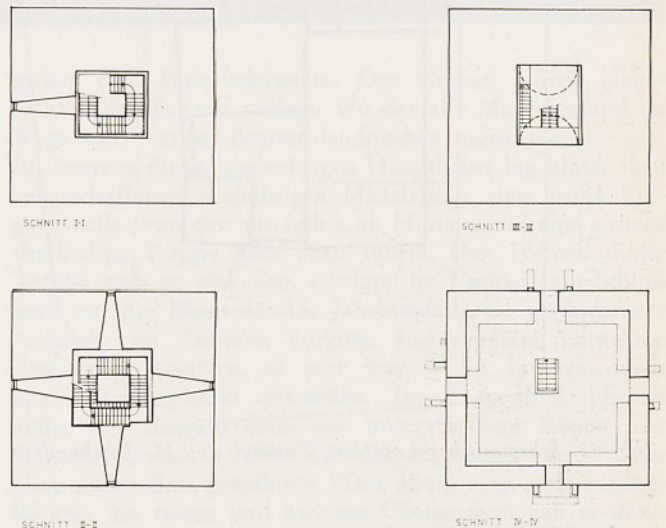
Bergfried im derzeitigen Zustand. Grundrisse in vier Ebenen (Zeichnungen: W.-G. Fleck)
